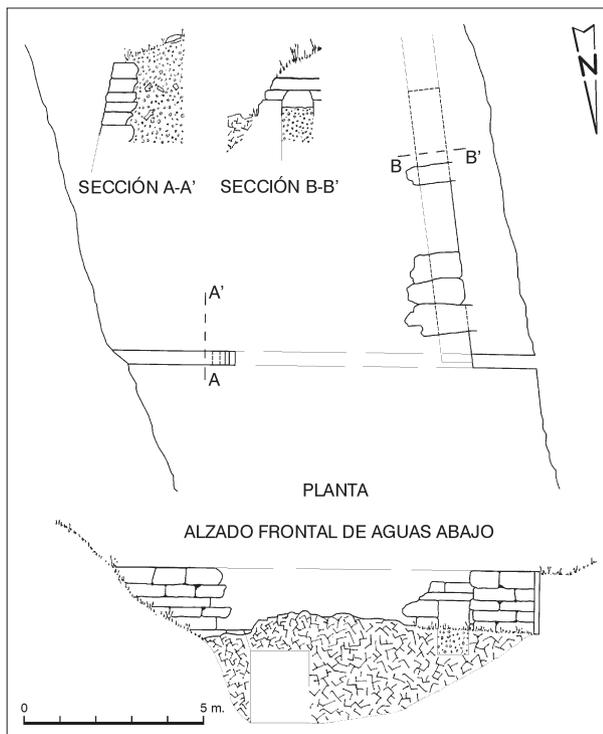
La presa de Valbuena: Planta, alzado, sección transversal del estribo derecho y sección transversal del pasadizo de acceso al mecanismo de la compuerta.
